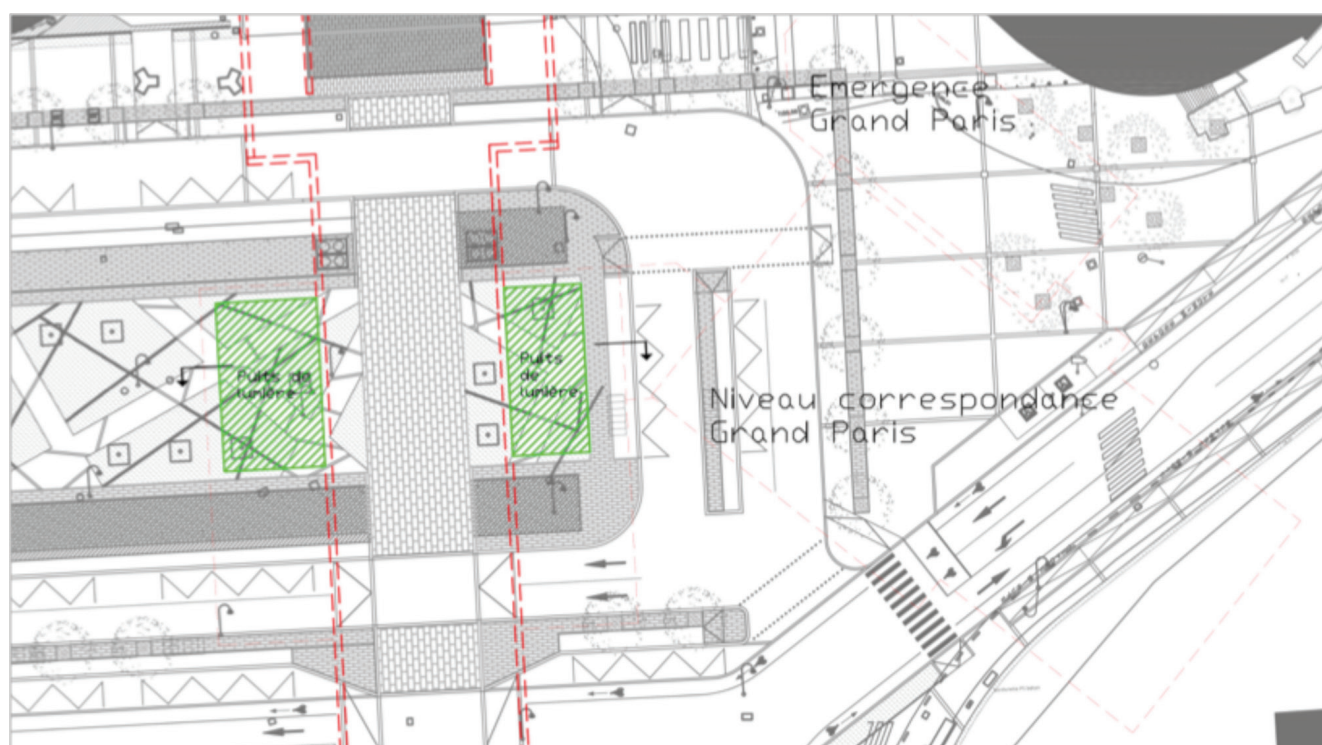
Plan niveau 0 (niveau voirie) en gare de Sevrans Beaudottes
